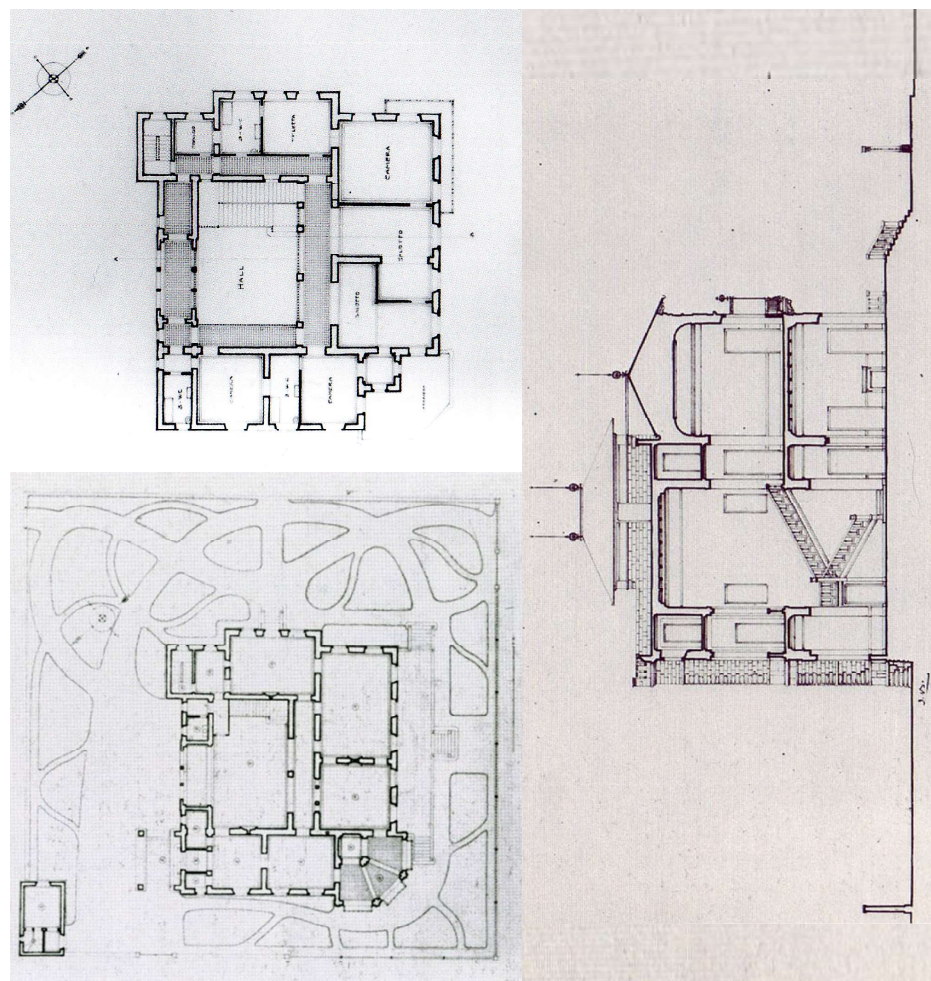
Villino Delliella, pianta del piano terra, pianta del piano primo e sezione, progetto definitivo 1905 (Archivio dotazione Basile).
